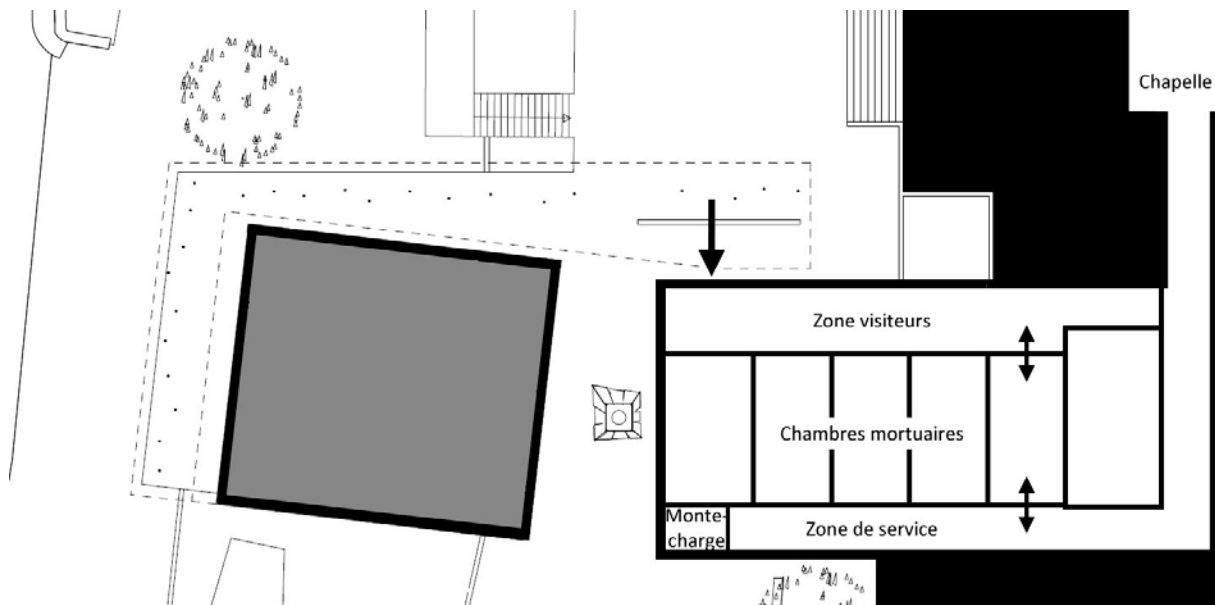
Plan du rez-de-chaussée (auteur : Bureau MSBR Nouvelle Génération)
